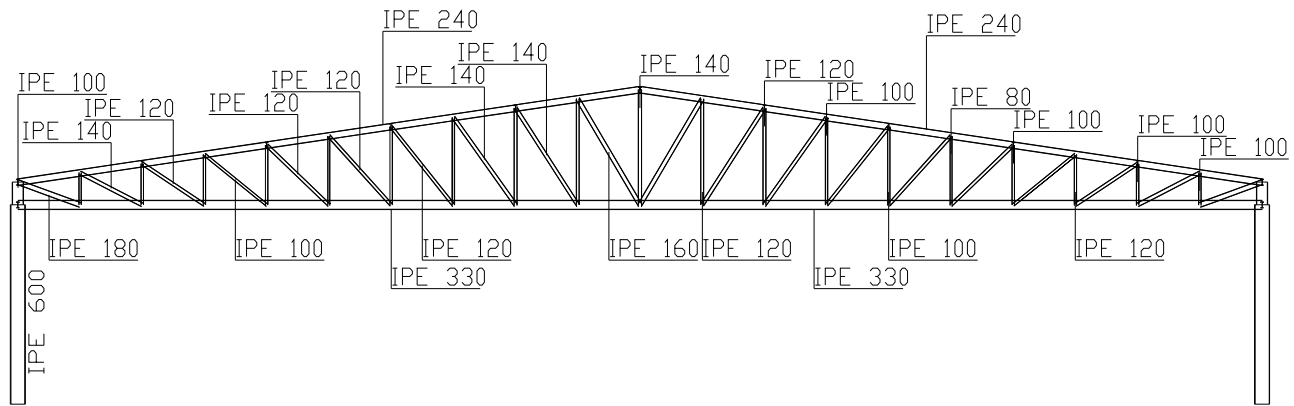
Pórtico com pilar de alma cheia, viga em treliça, vão de 50.00m, pilar e viga em perfil com secção transversal IPE.
